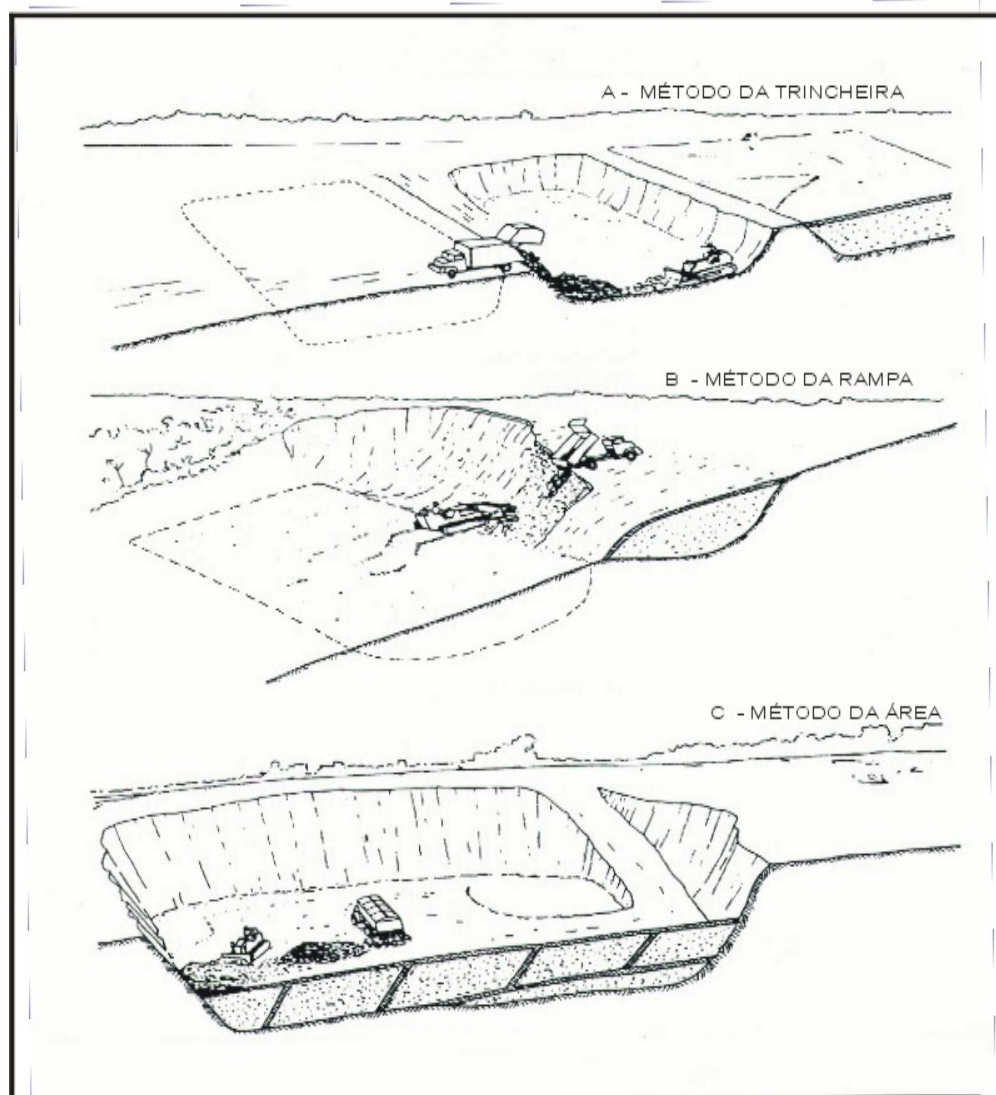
Métodos operacionais utilizados para a construção de aterro sanitário.
